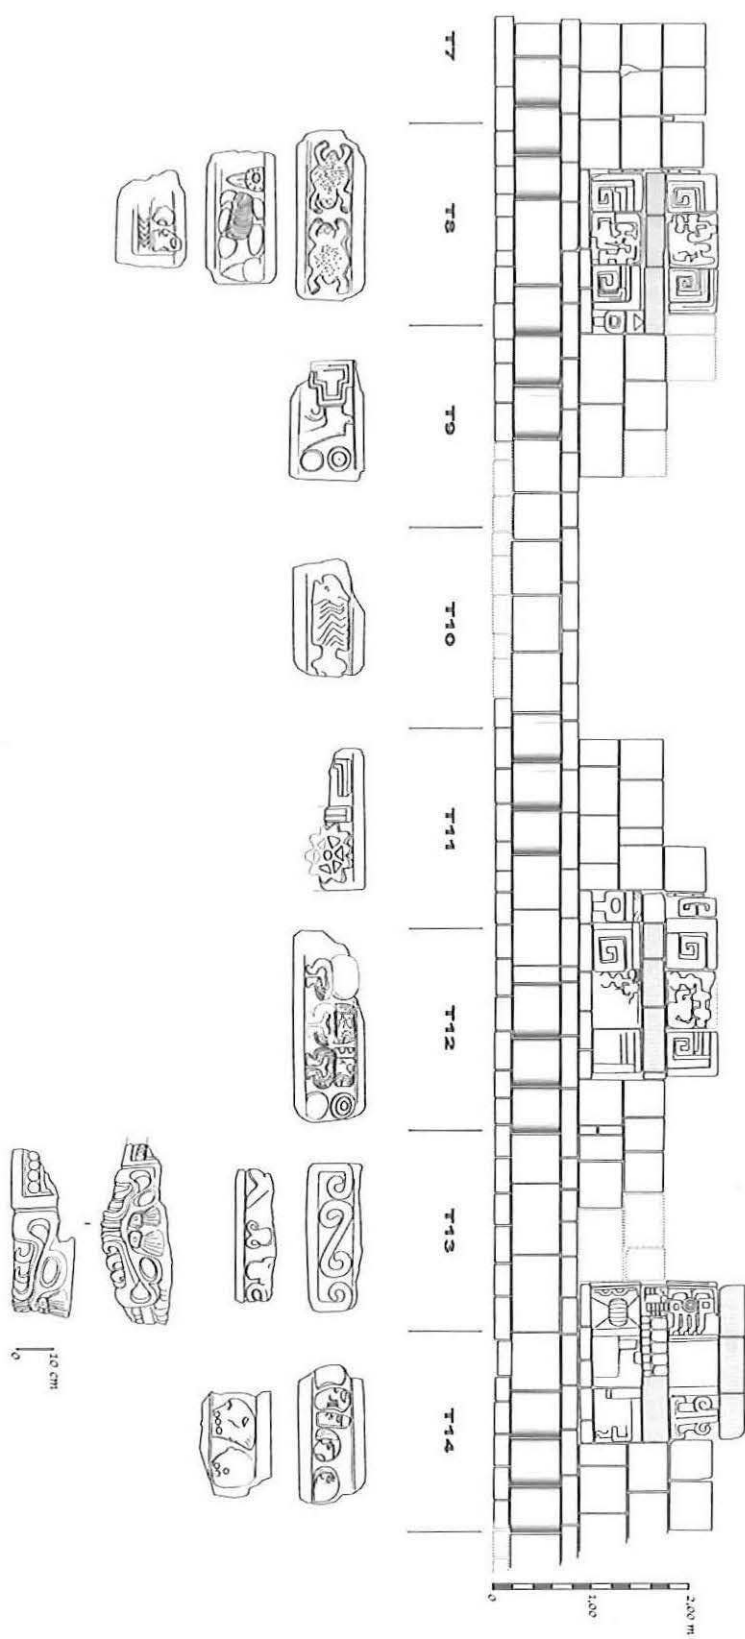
Alzado de la parte excavada durante la temporada 2004 en la fachada norte del edificio con torres del grupo A de Rio Bec (Dibujo de Latsanopoulos)
